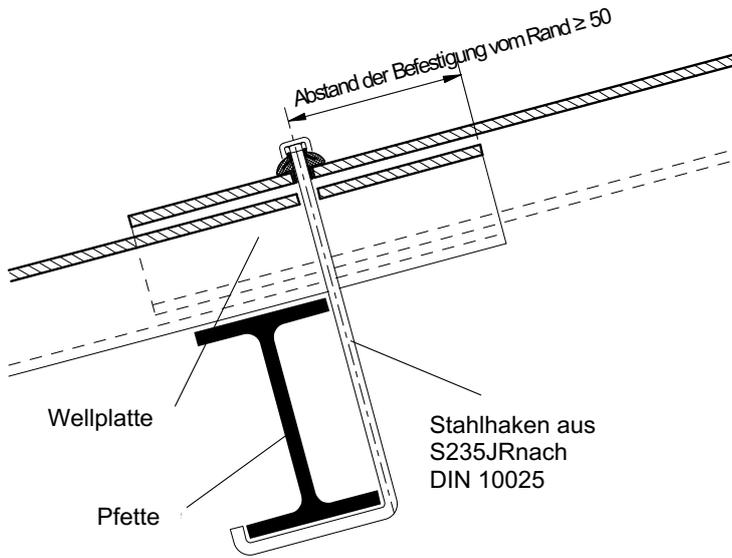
Anordnung der Befestigung bei Stahl-Unterkonstruktionen mit Stahlhaken
